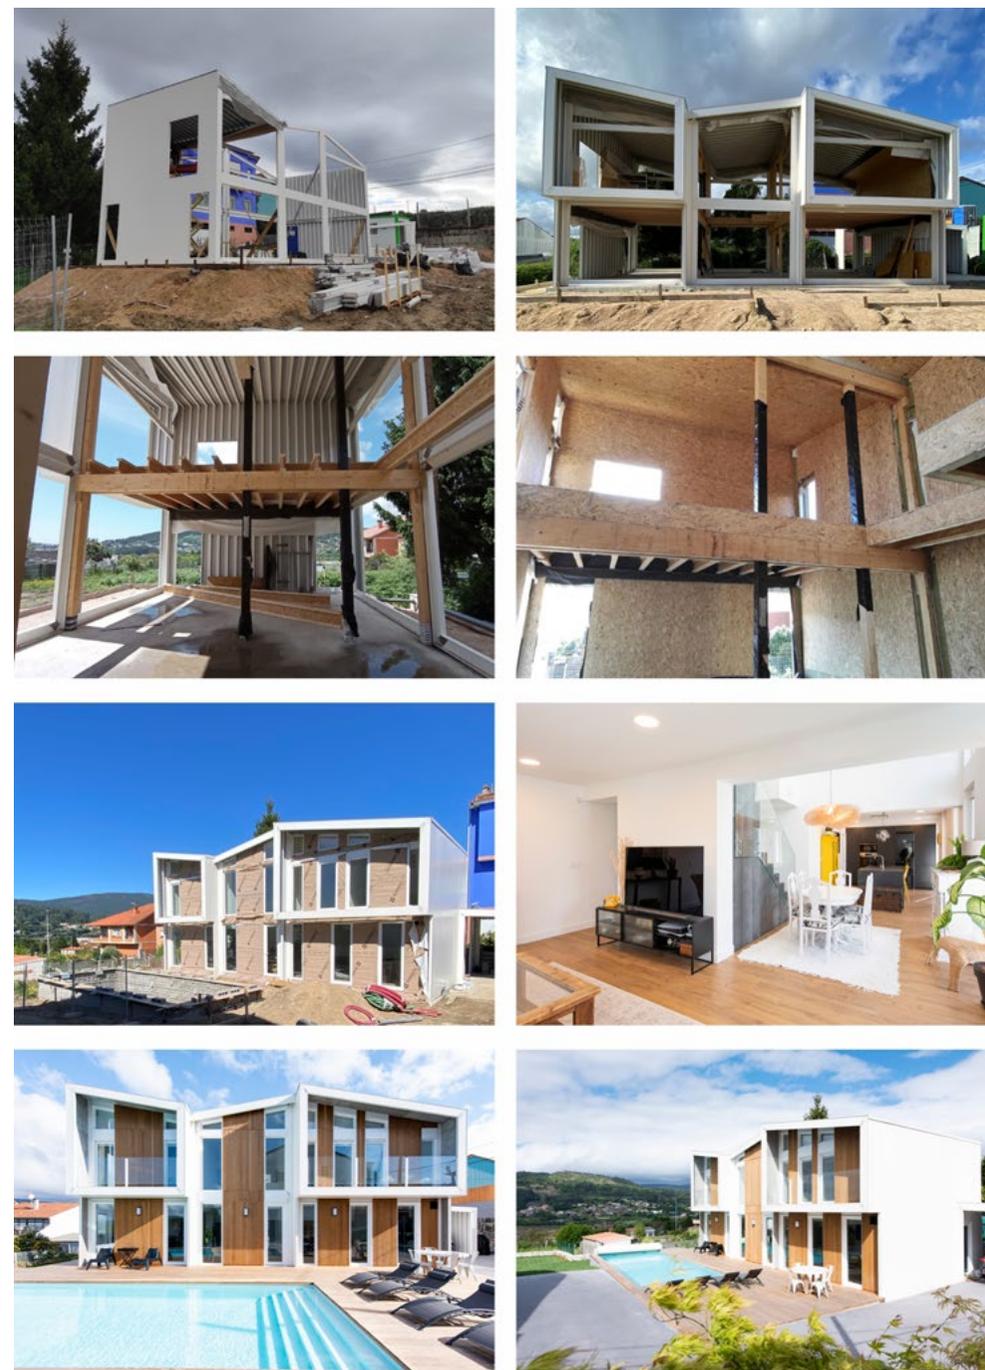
Reportaje fotográfico de la construcción de la Vivienda Pontevedra ACG.
